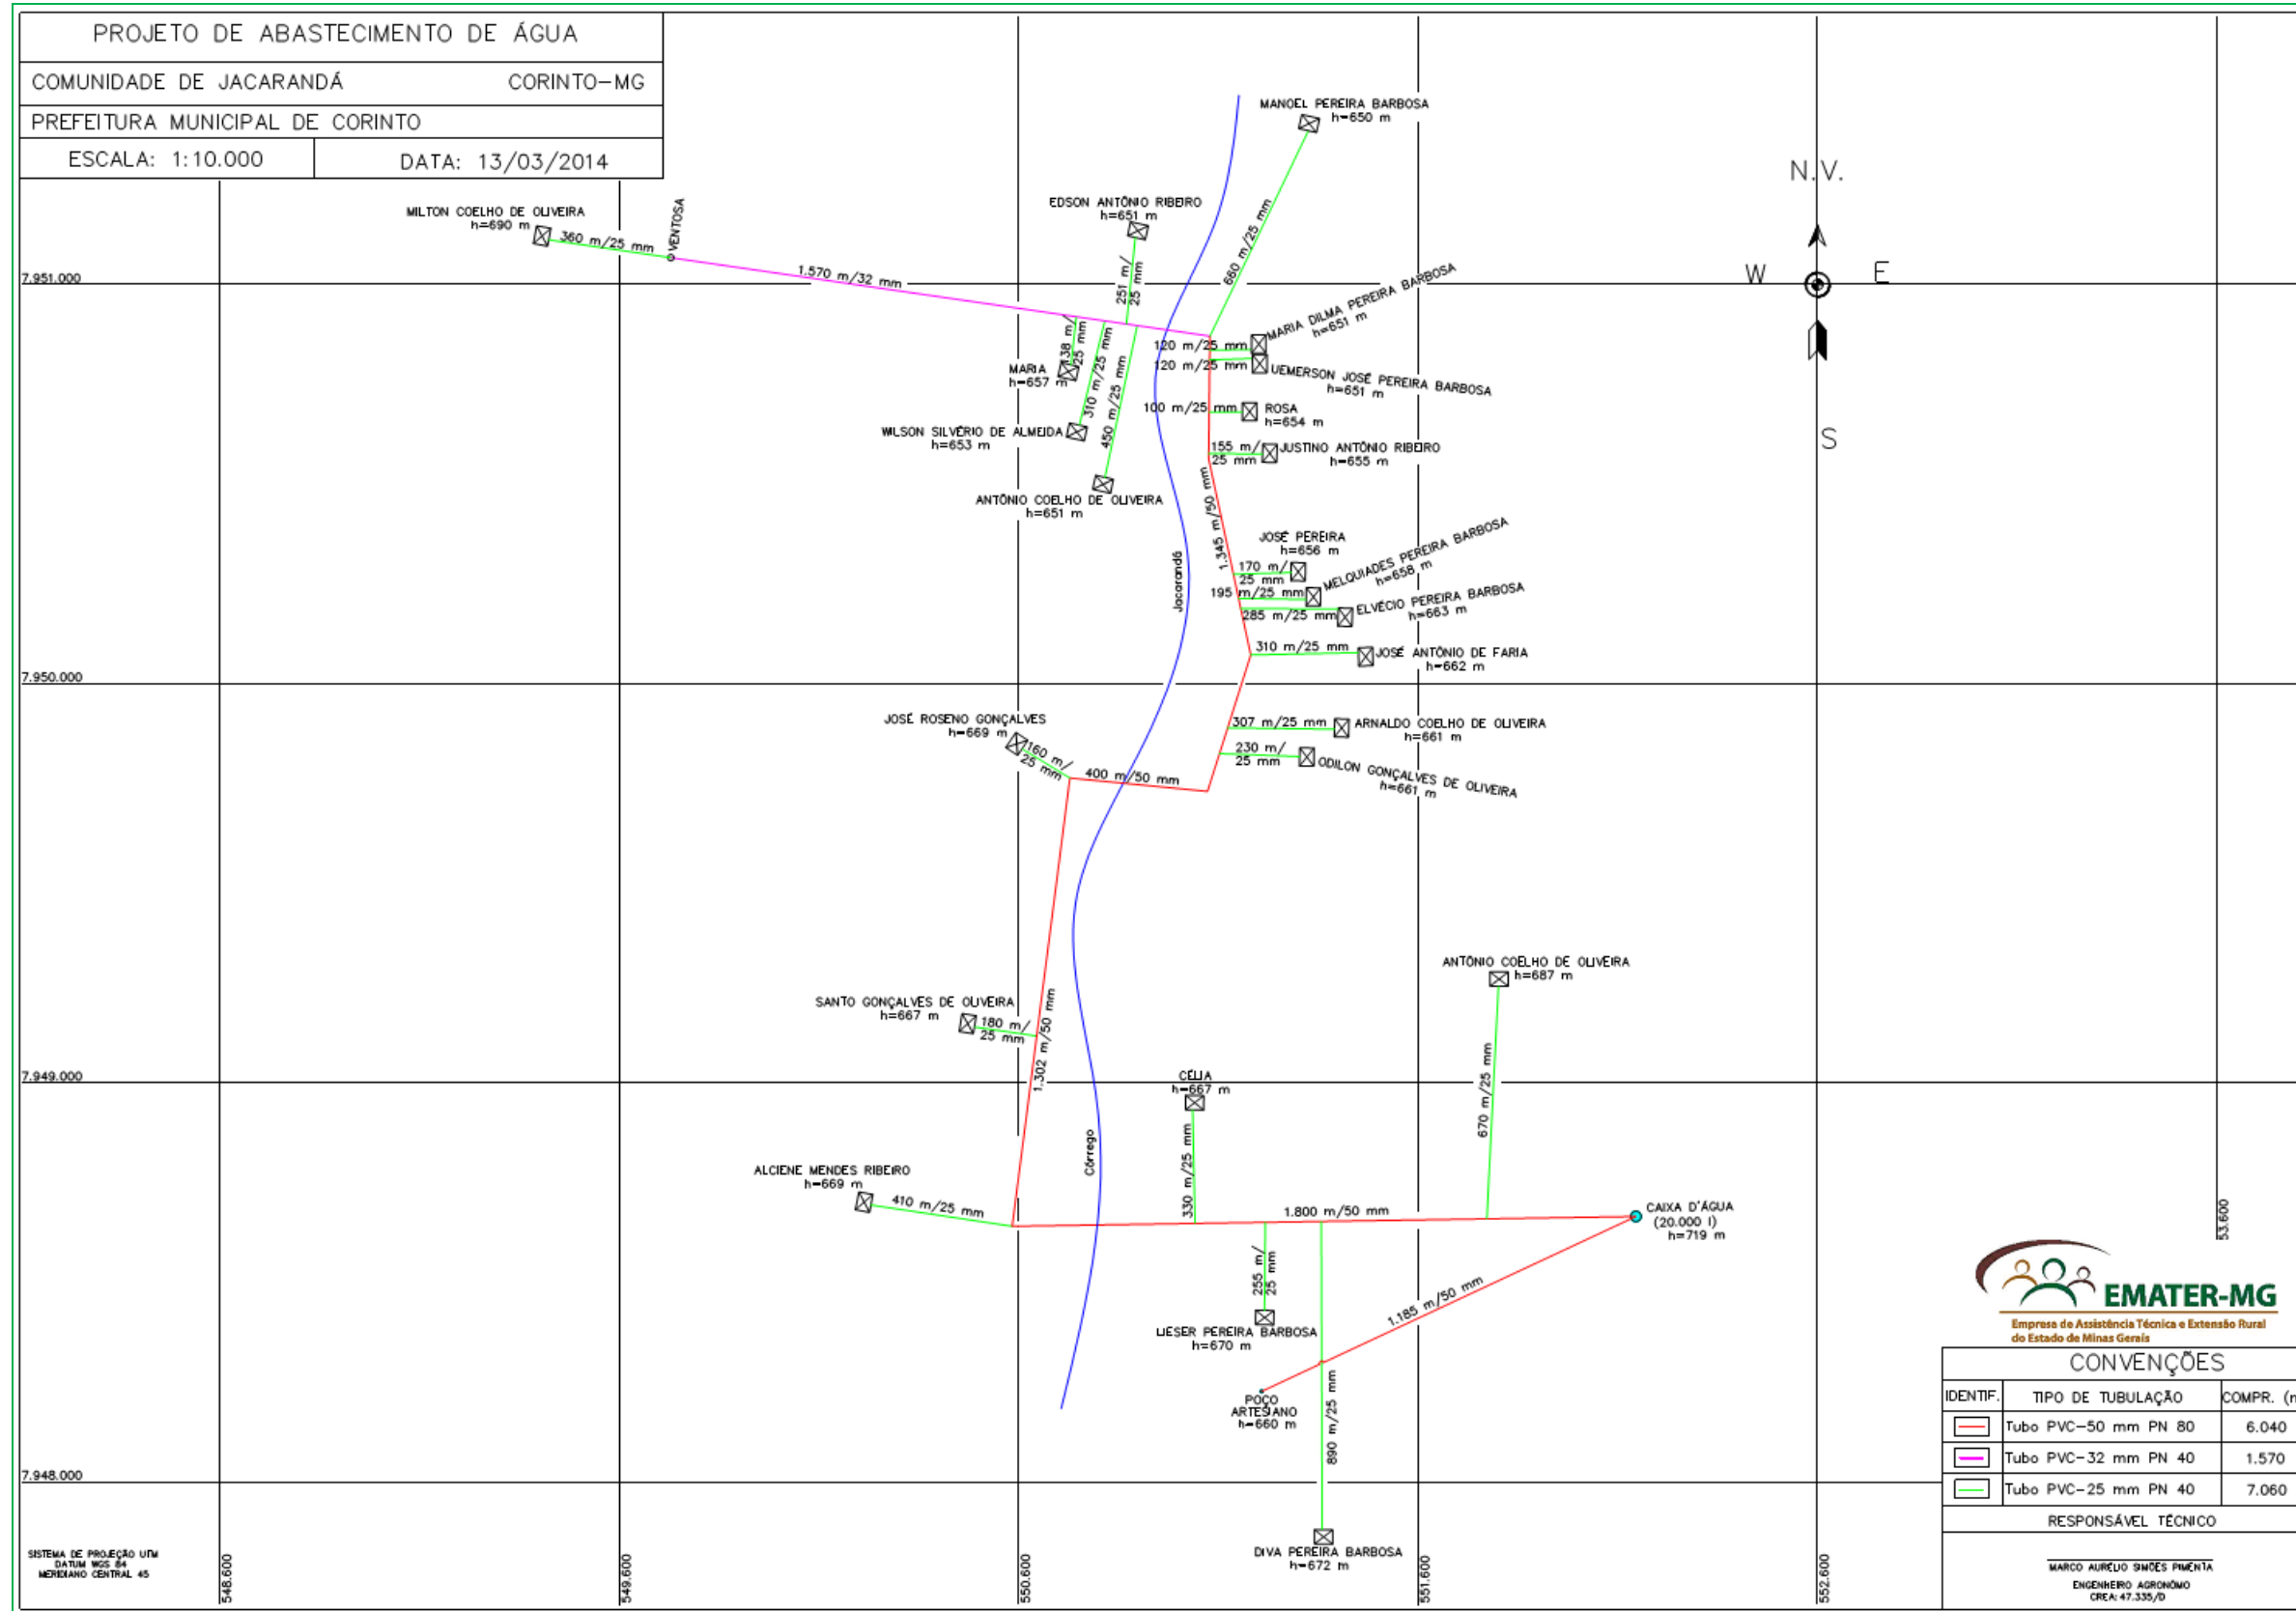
Planta do SSAA elaborado pela EMATER.
